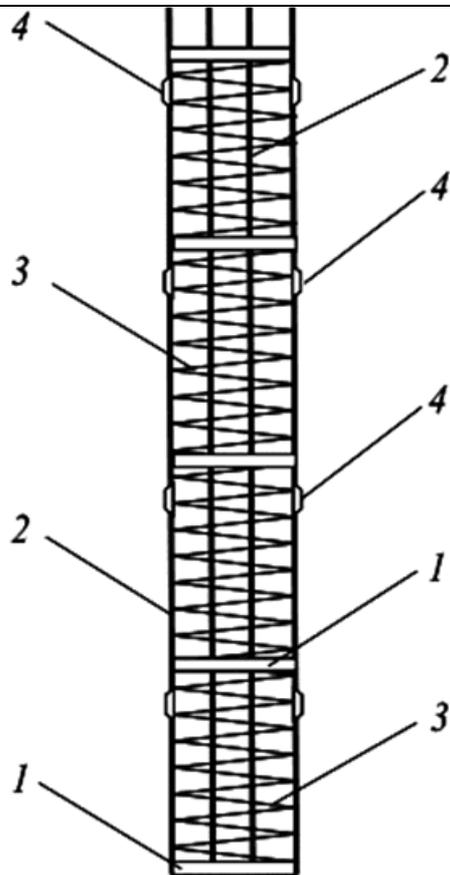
Конструкция арматурного каркаса буронабивной сваи:
